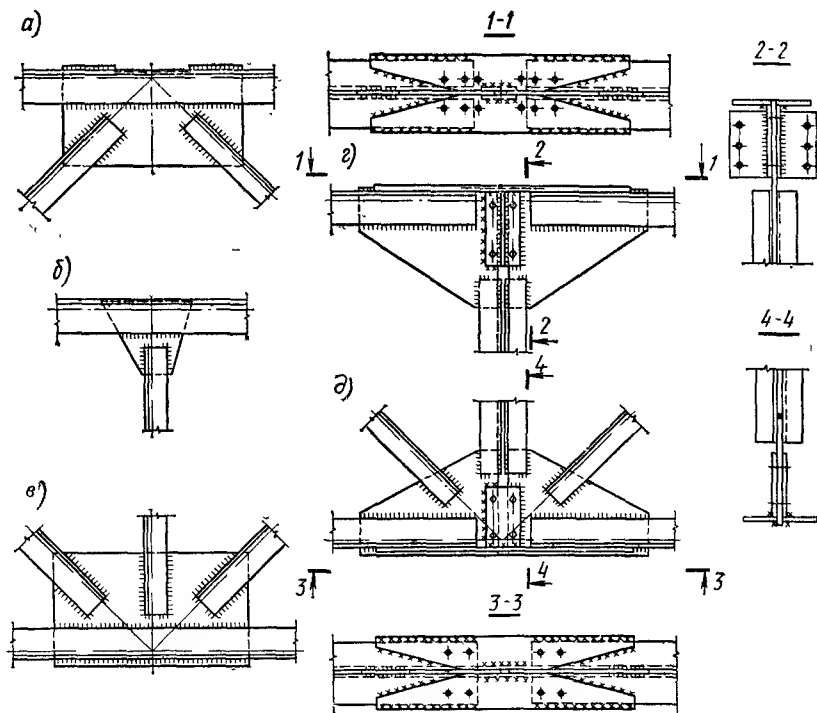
Заводские узлы и монтажные стыки стропильных ферм с элементами из парных уголков
